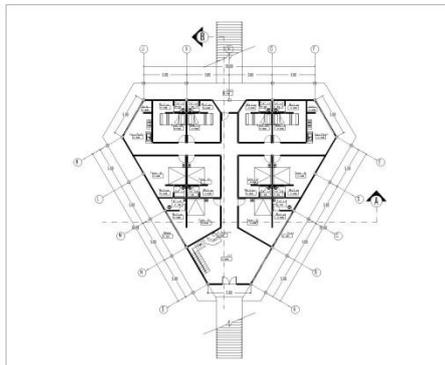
Denah Lantai 2 Ged. B (Foodcourt)
